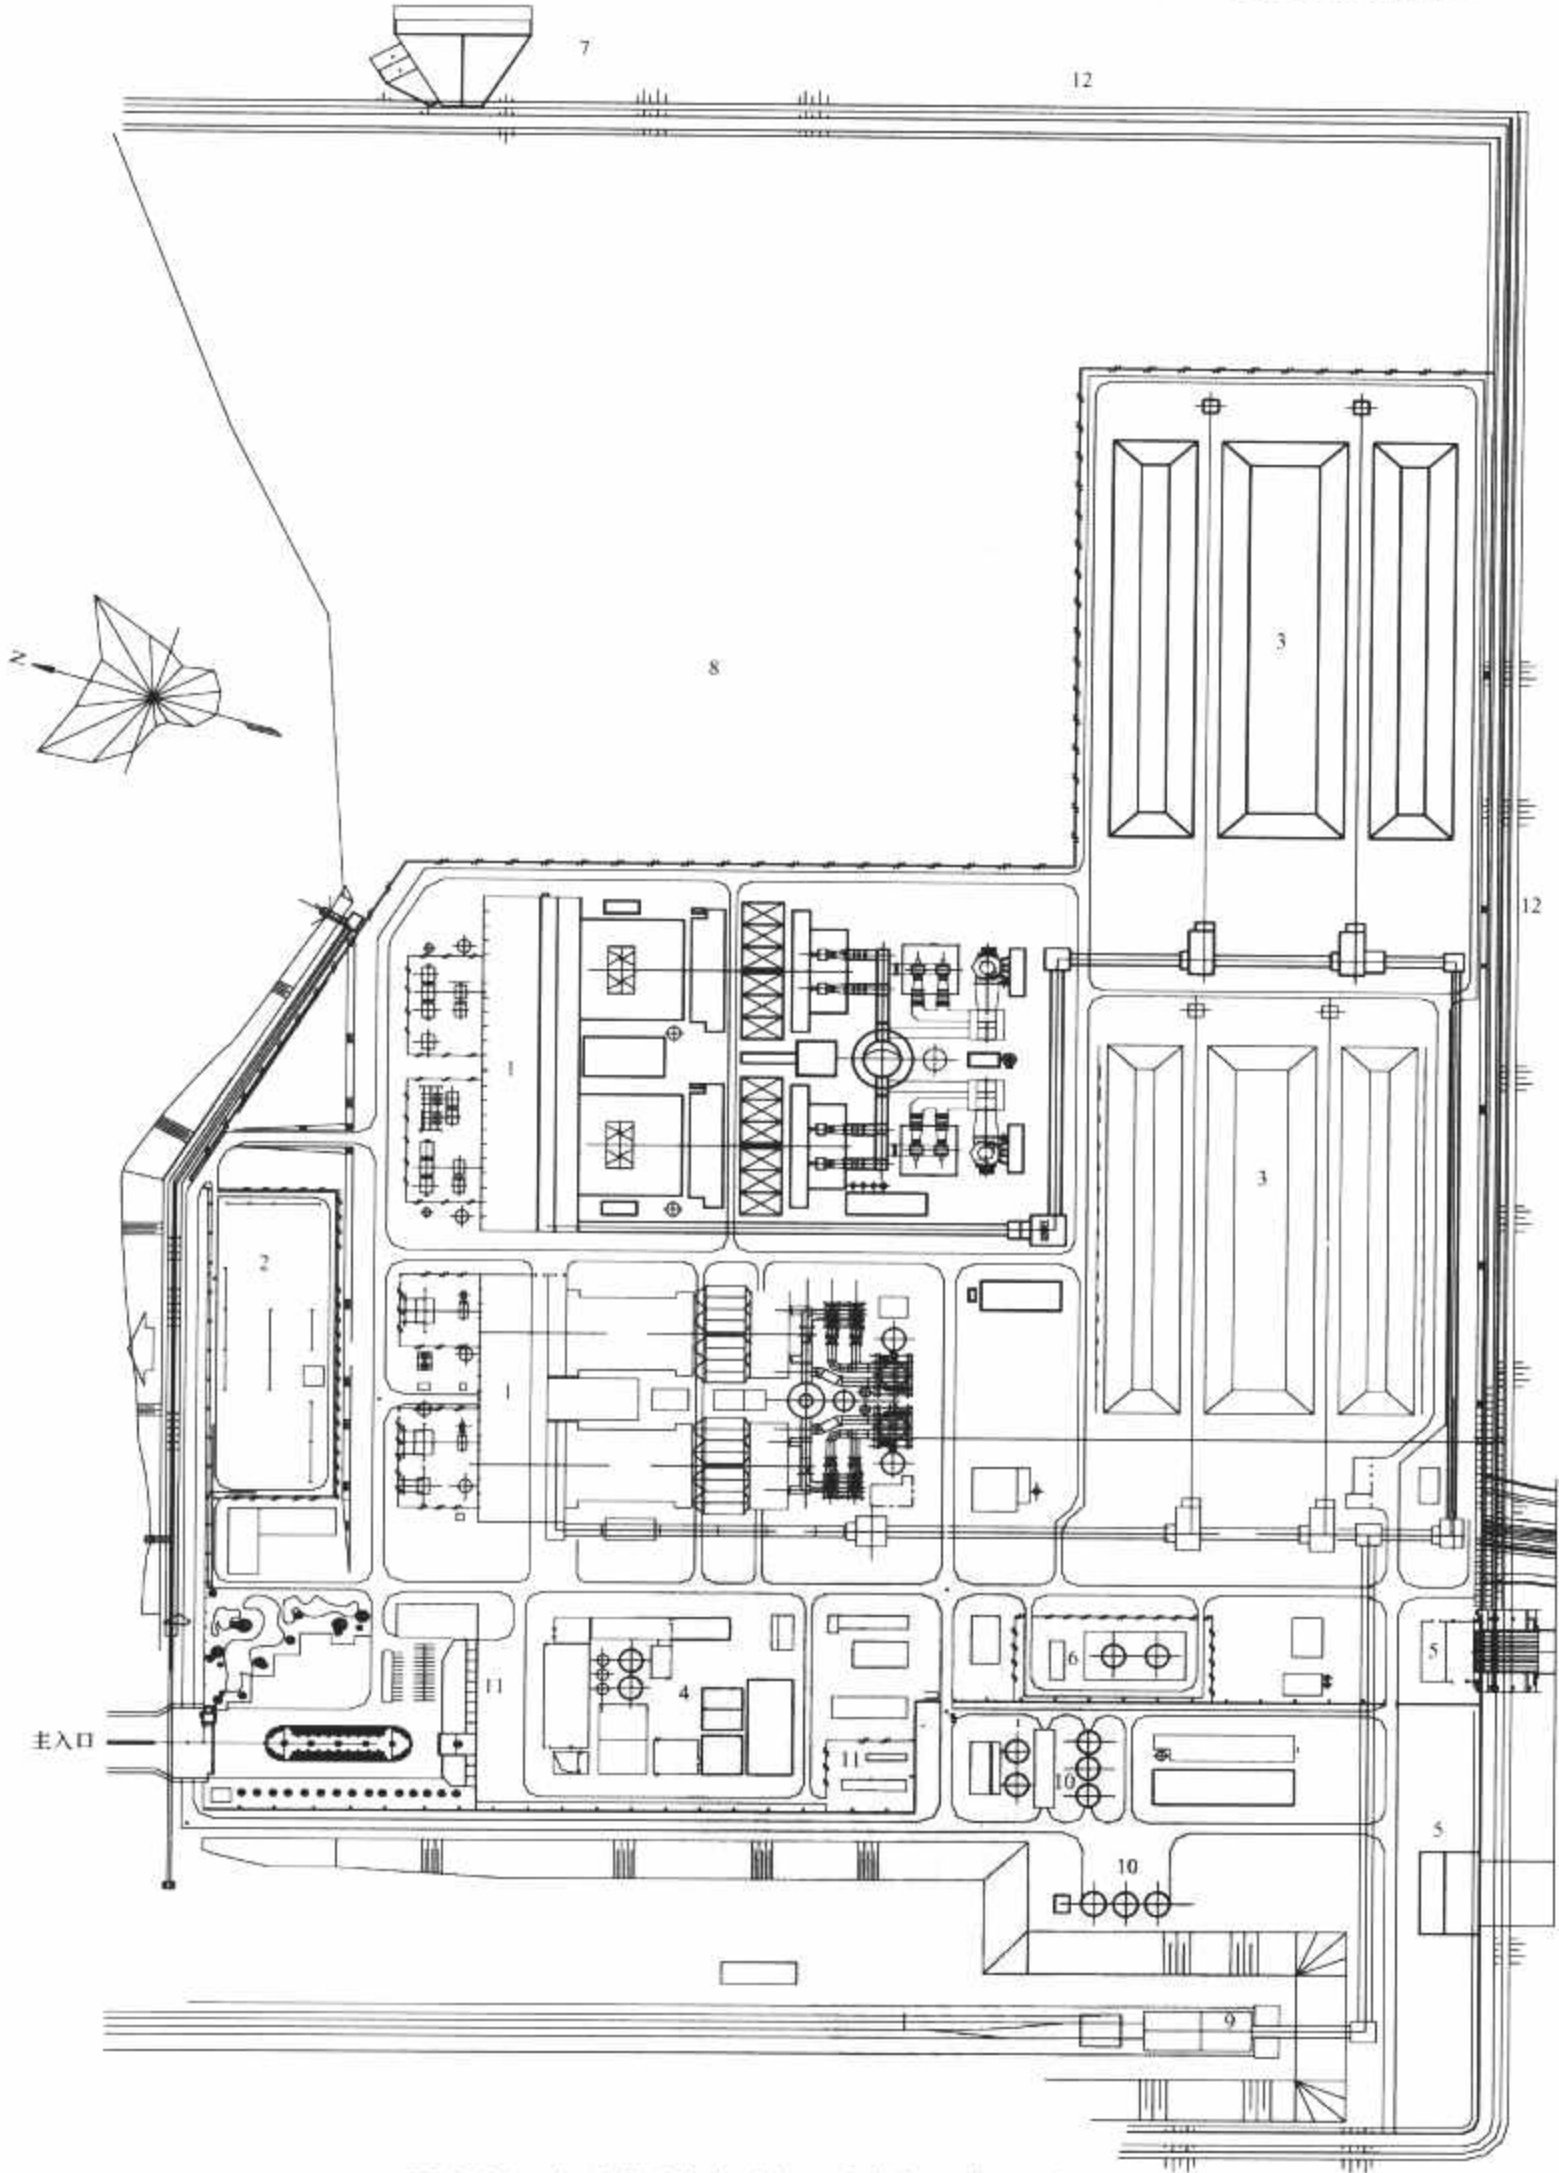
锅炉房面向水源的三列式电厂总平面布置图
